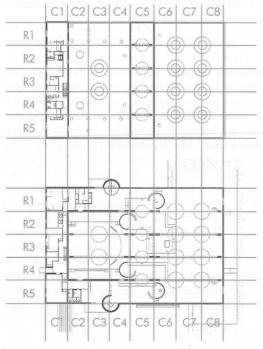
Esquema compositivo de planta de la iglesia (planta baja y planta primera) basado en el rectángulo de Fibonacci y la sección áurea (Dibujo del autor)
